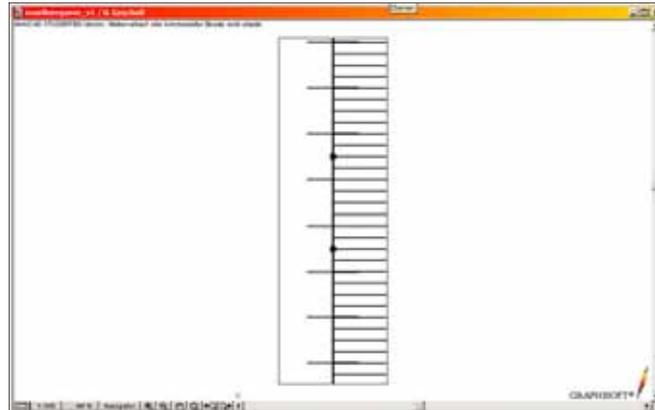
Grundrißdarstellung der Ebene: "Objekt 23_Dach"
